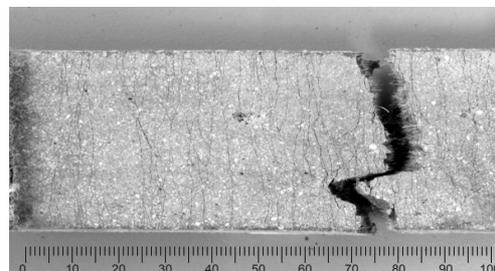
プリント試験体の引張载荷後のひび割れ状況
